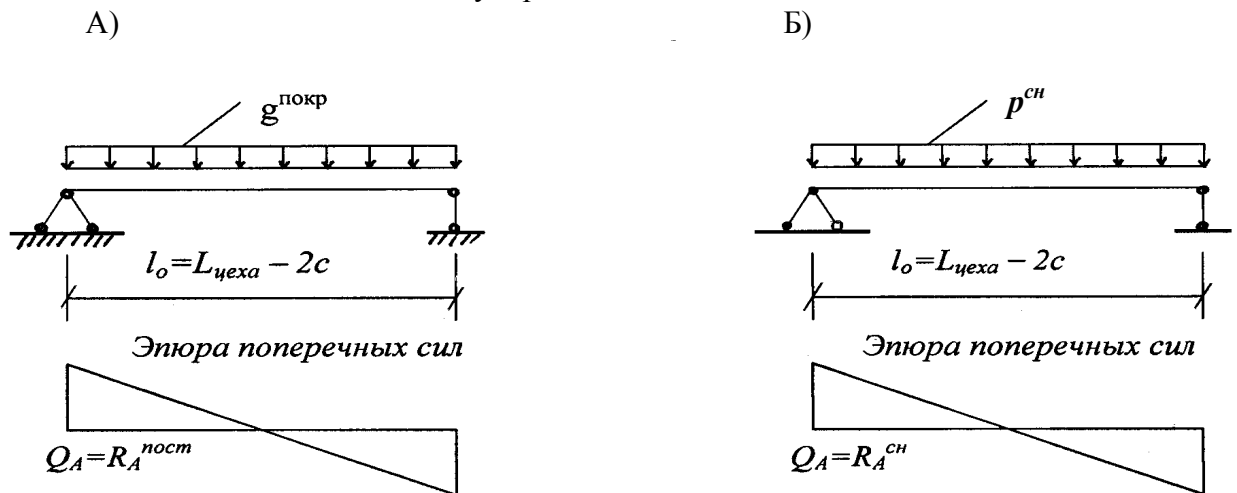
Расчетная схема стропильной конструкции при определении опорной реакции R_A :
